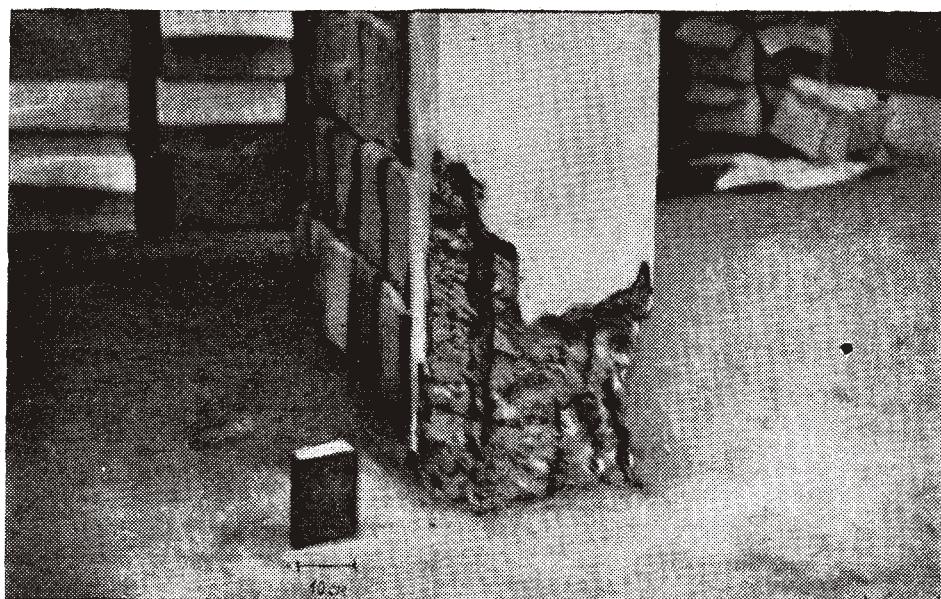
Выкрашивание железобетонной колонны. Здание жестянобаночной фабрики (1-й завод, Усть-Камчатск).
